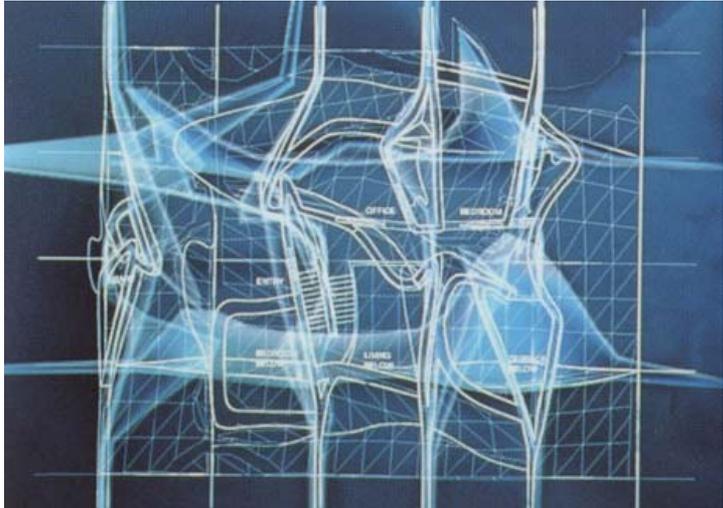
,22: Das virtual house, Grundriss EG, Längsschnitt (Eisenman, 1997)
